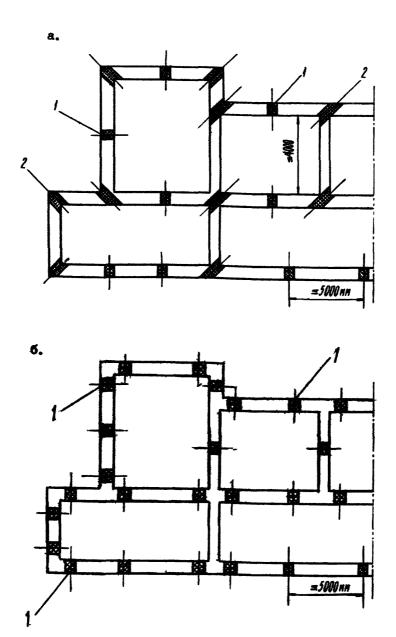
Схемы расположения домкратных ниш в плане:
